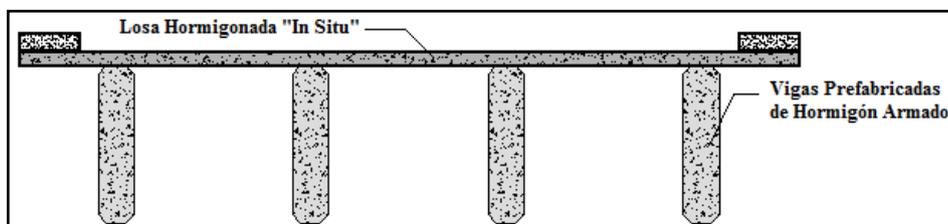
Vigas de Hormigón armado con losa “in situ”.
